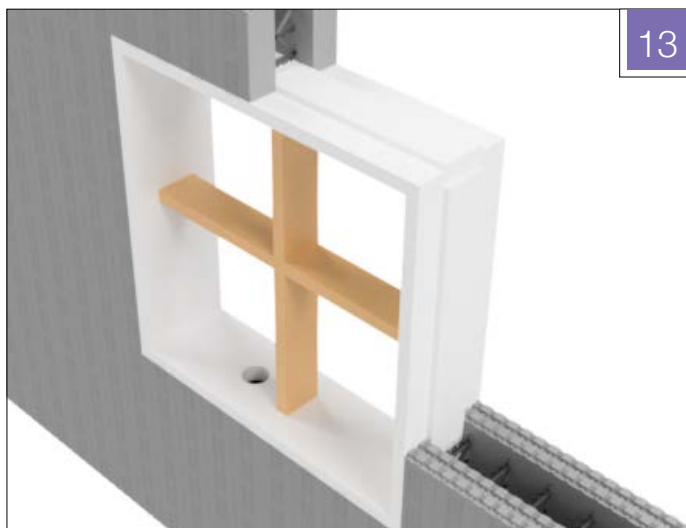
Bruk tverrgående bord for fastholding av rammen. I underkant av rammen lages inspeksjonshull slik at betongstøpingen kan følges visuelt og slik at betongen kommer til under åpningen.
